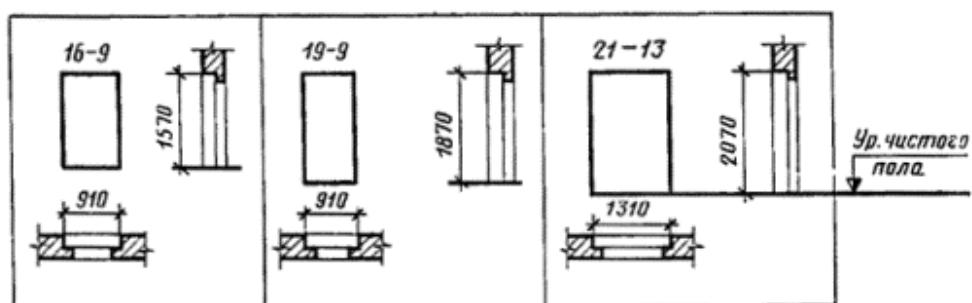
Размеры дверных проёмов в наружных стенах (ТИП С)
